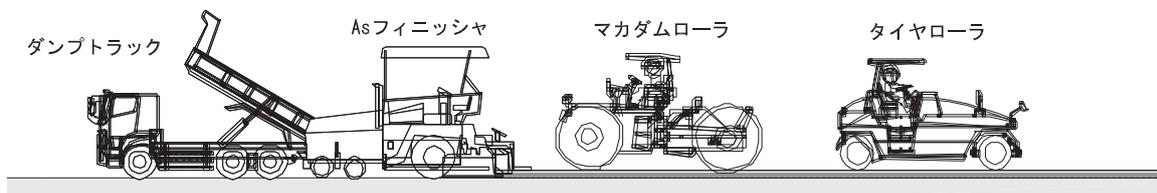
アスファルト舗装工（基層）の施工状況
